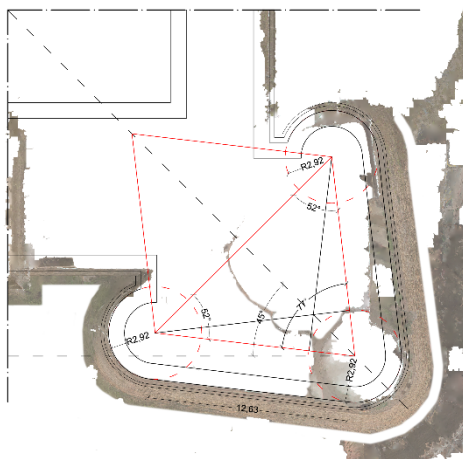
Sovrapposizione della mesh ottenuta da fotomodellazione e la ricostruzione geometrica. La linea guida è stata la prima dall'alto appartenente al lato esterno del parapetto murario
